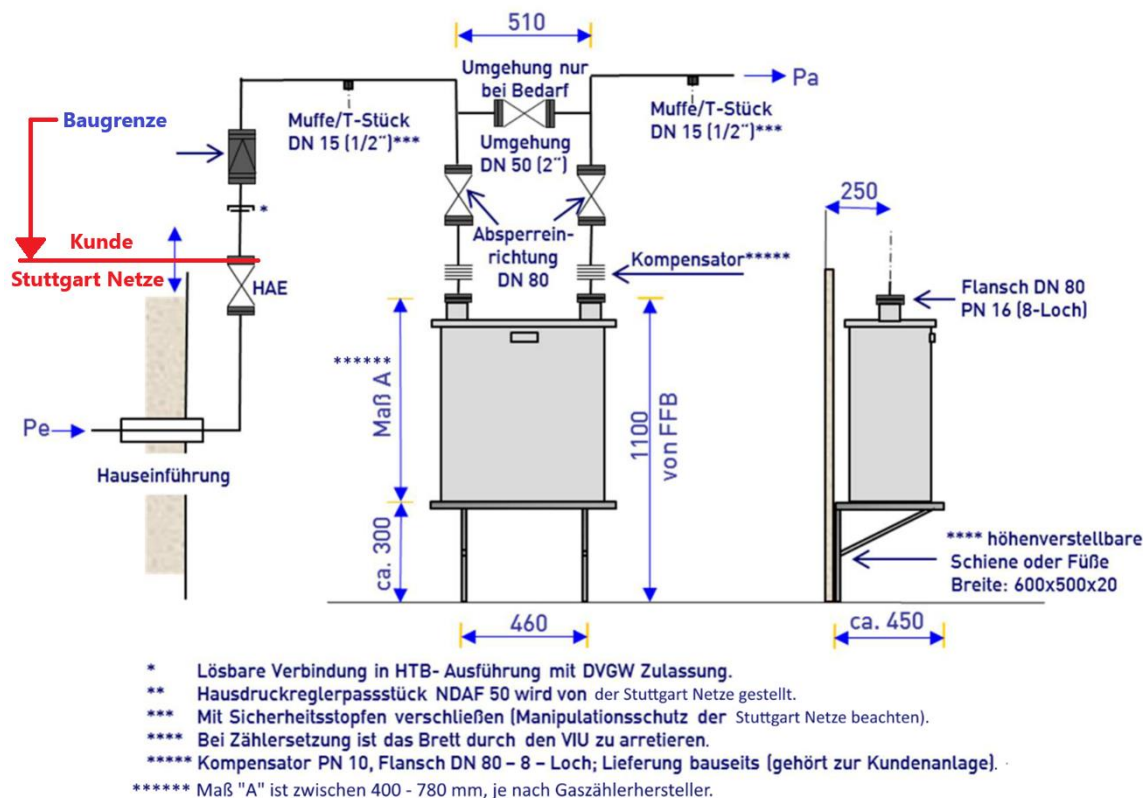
Ausführungsbeispiel G 40 Zähler im Niederdruck; Bild-Quelle: TIV G/W Netze BW
